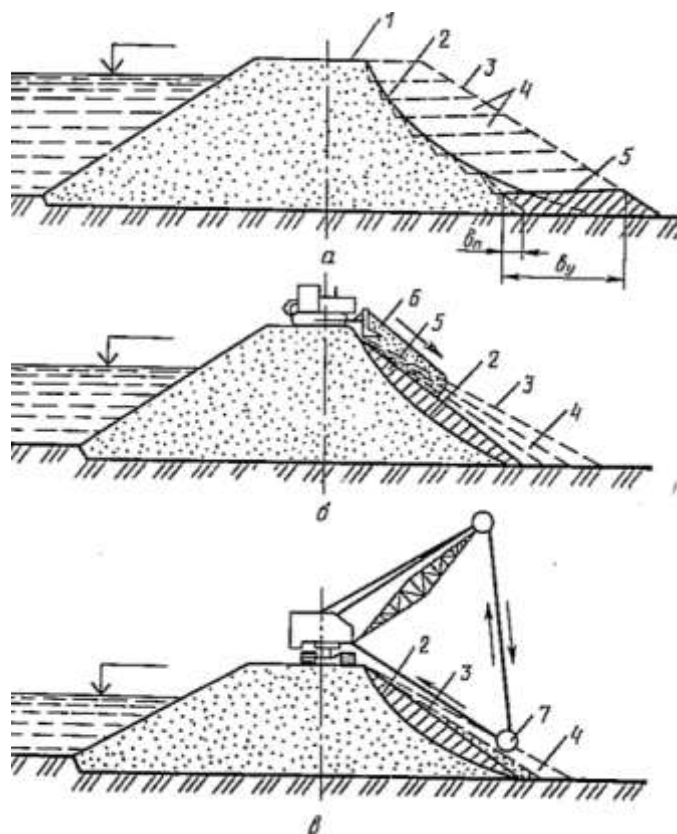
Схема уширения и упрочивания откосов грунтовых плотин [23]: а и б – продольный и поперечный способы; в – уплотнение грунта катком; 1 – гребень плотины; 2 – низовой откос до ремонта; 3 – проектный откос; 4 – слой отсыпки и уплотнения грунта; 5 – уплотнённый грунт; 6 – грунт, разравниваемый бульдозером; 7 – каток
